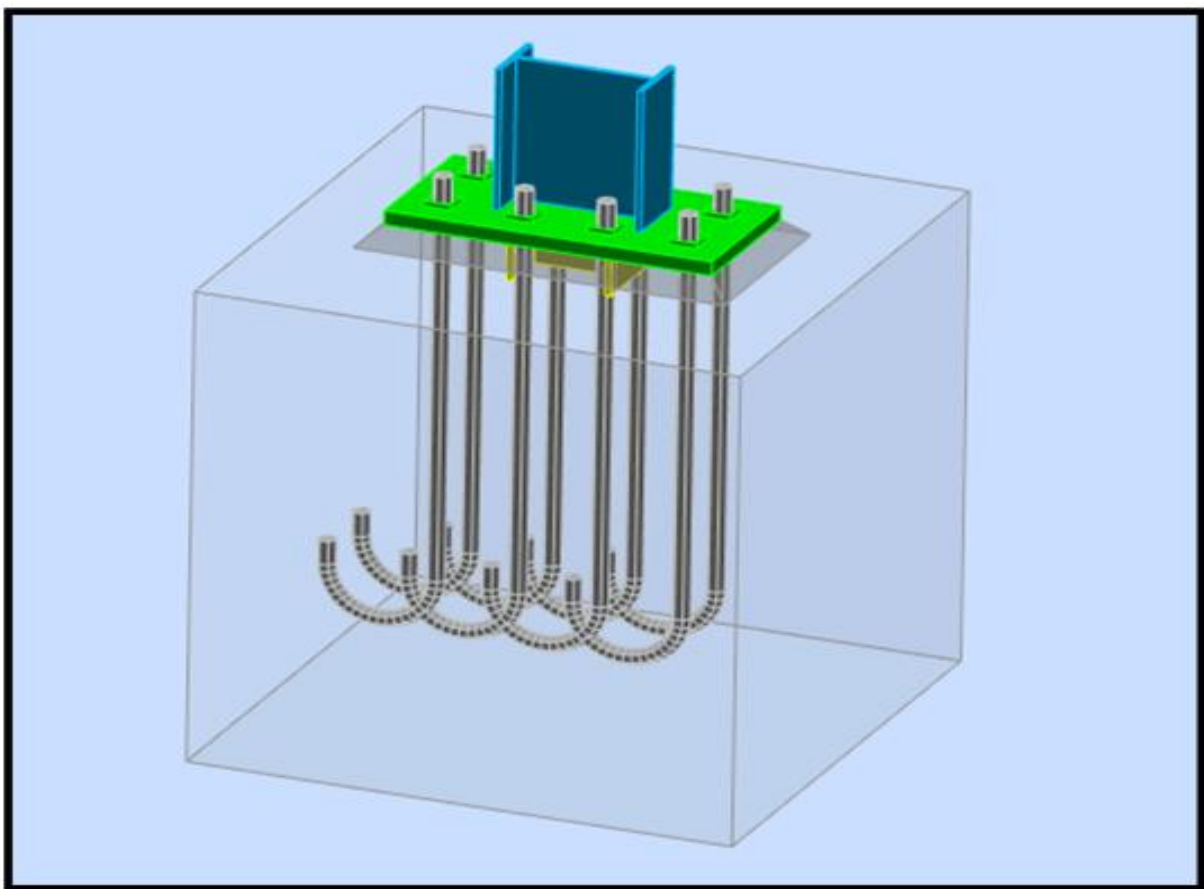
Vue en 3D de l'assemblage pied de poteau
